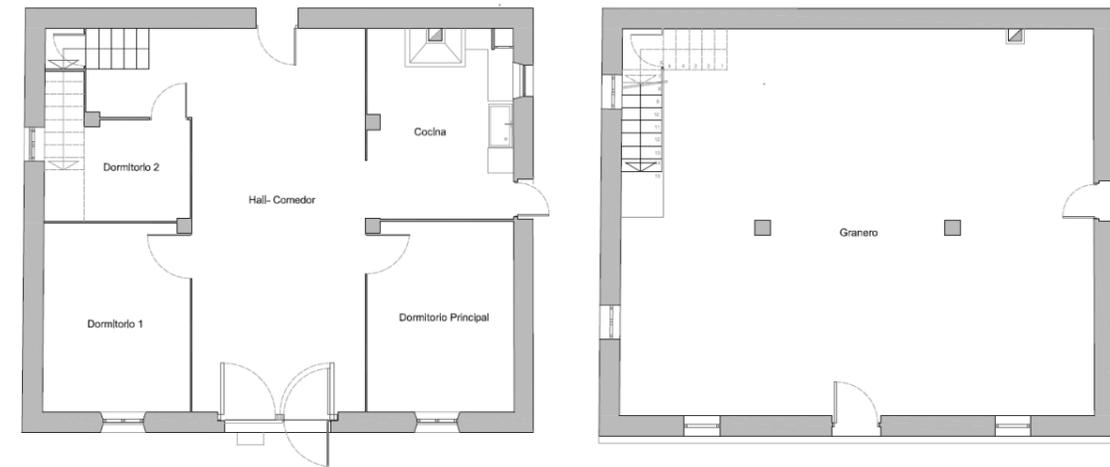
Segunda Fase Alquería Visquet. Planta Baja y Planta Primera. Fuente: autor propio
